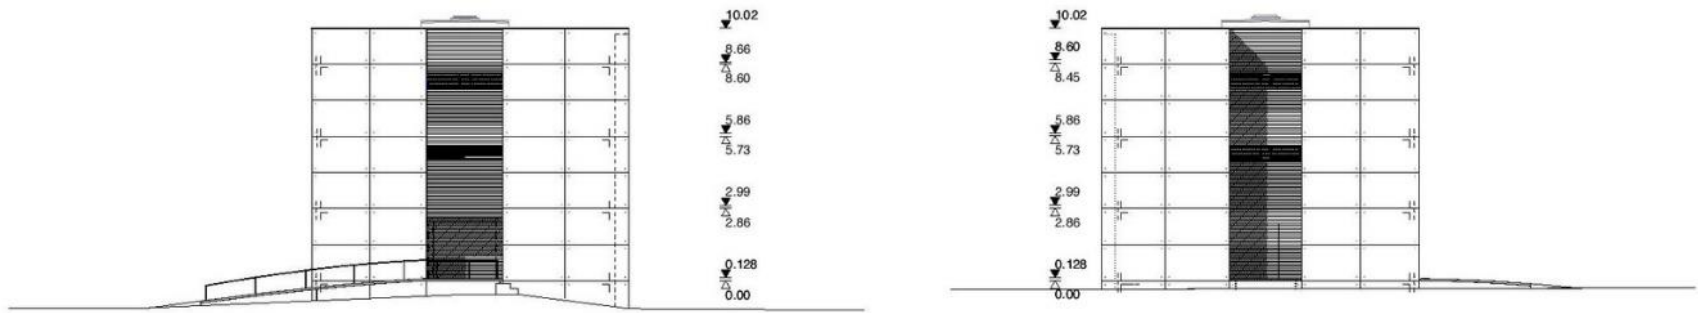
Alzados Norte y Sur de la Residencia para Estudiantes, FUENTE: Arch Daily
